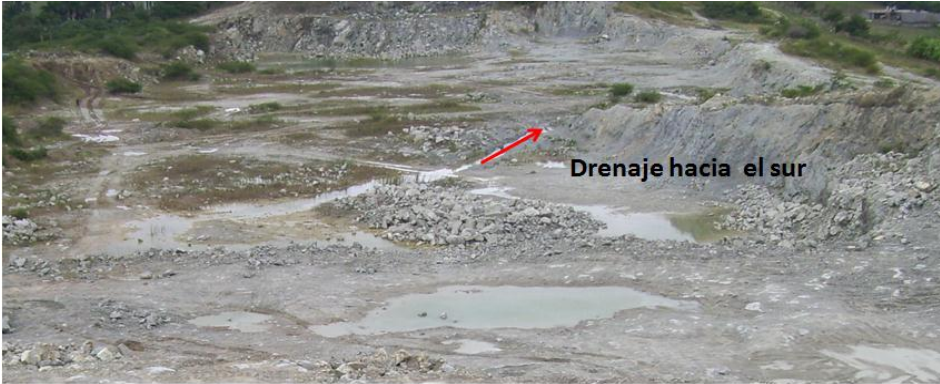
Drenaje Banco +90.0 m, hacia el sur
